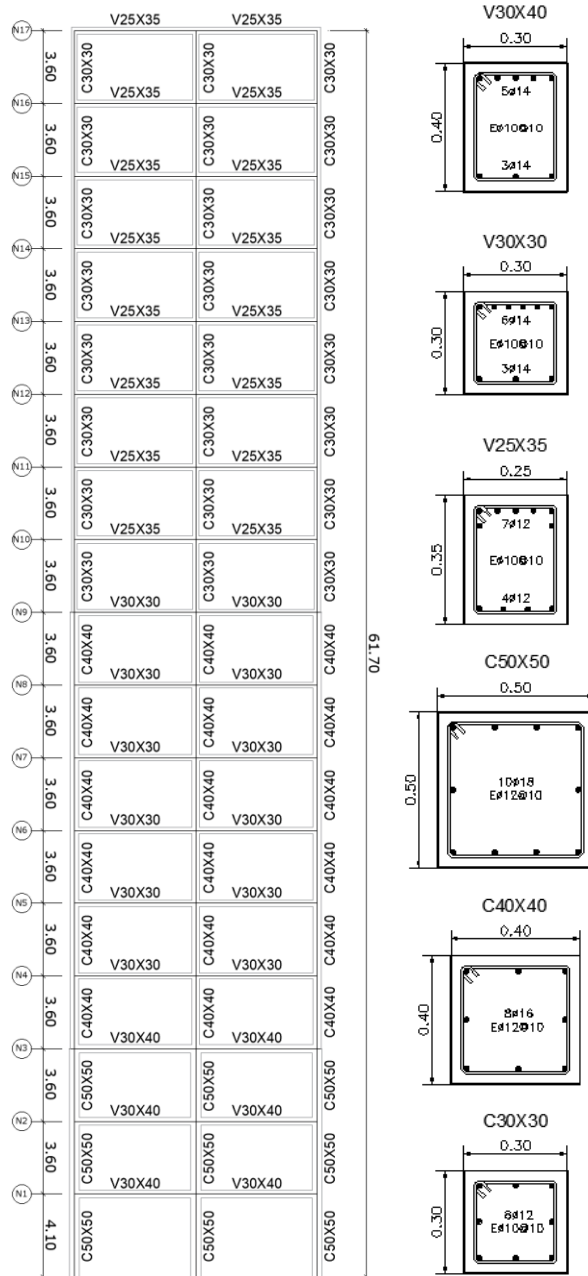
Pórtico estudiado (Plano A), secciones de hormigón armado (previo del diseño bajo cargas gravitatorias).
